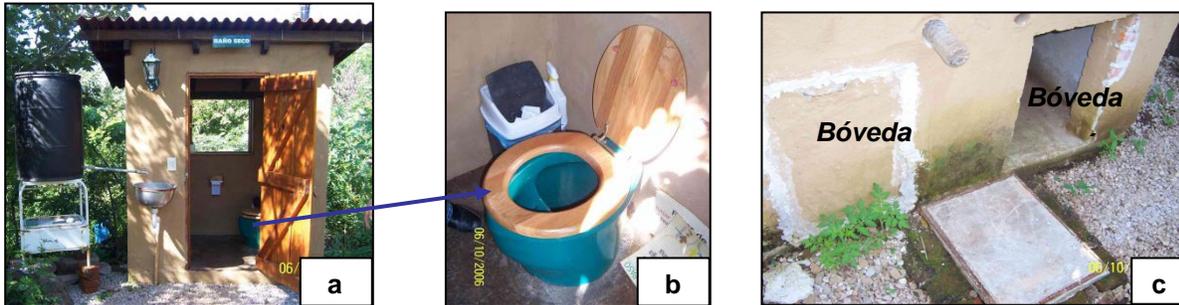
Sanitario separador seco ubicado en una estructura separada de la vivienda.
